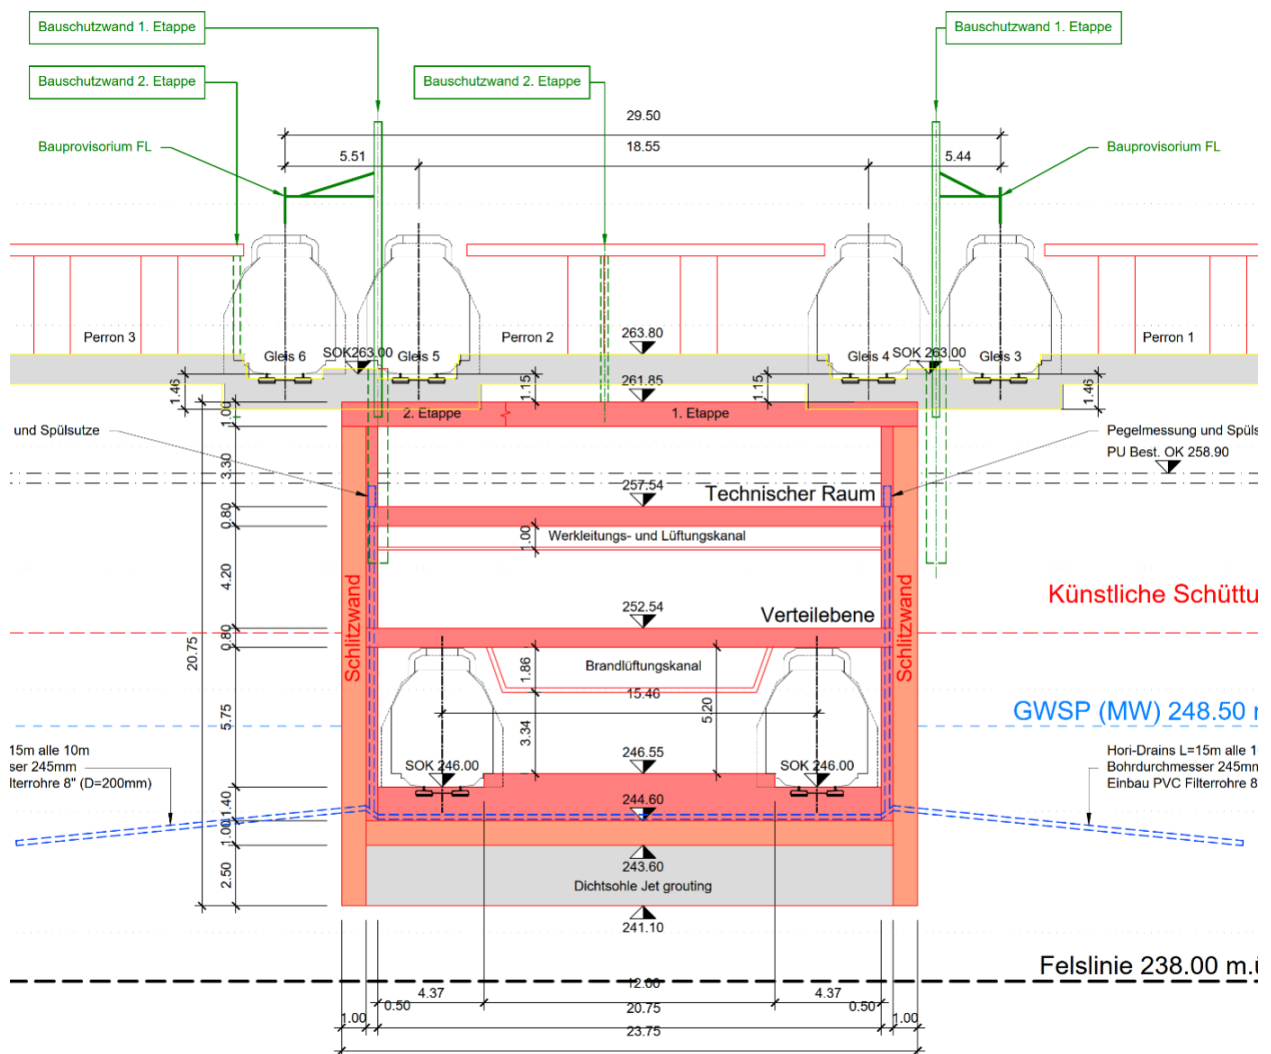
Normschnitt BADT (Deckelbauweise)
